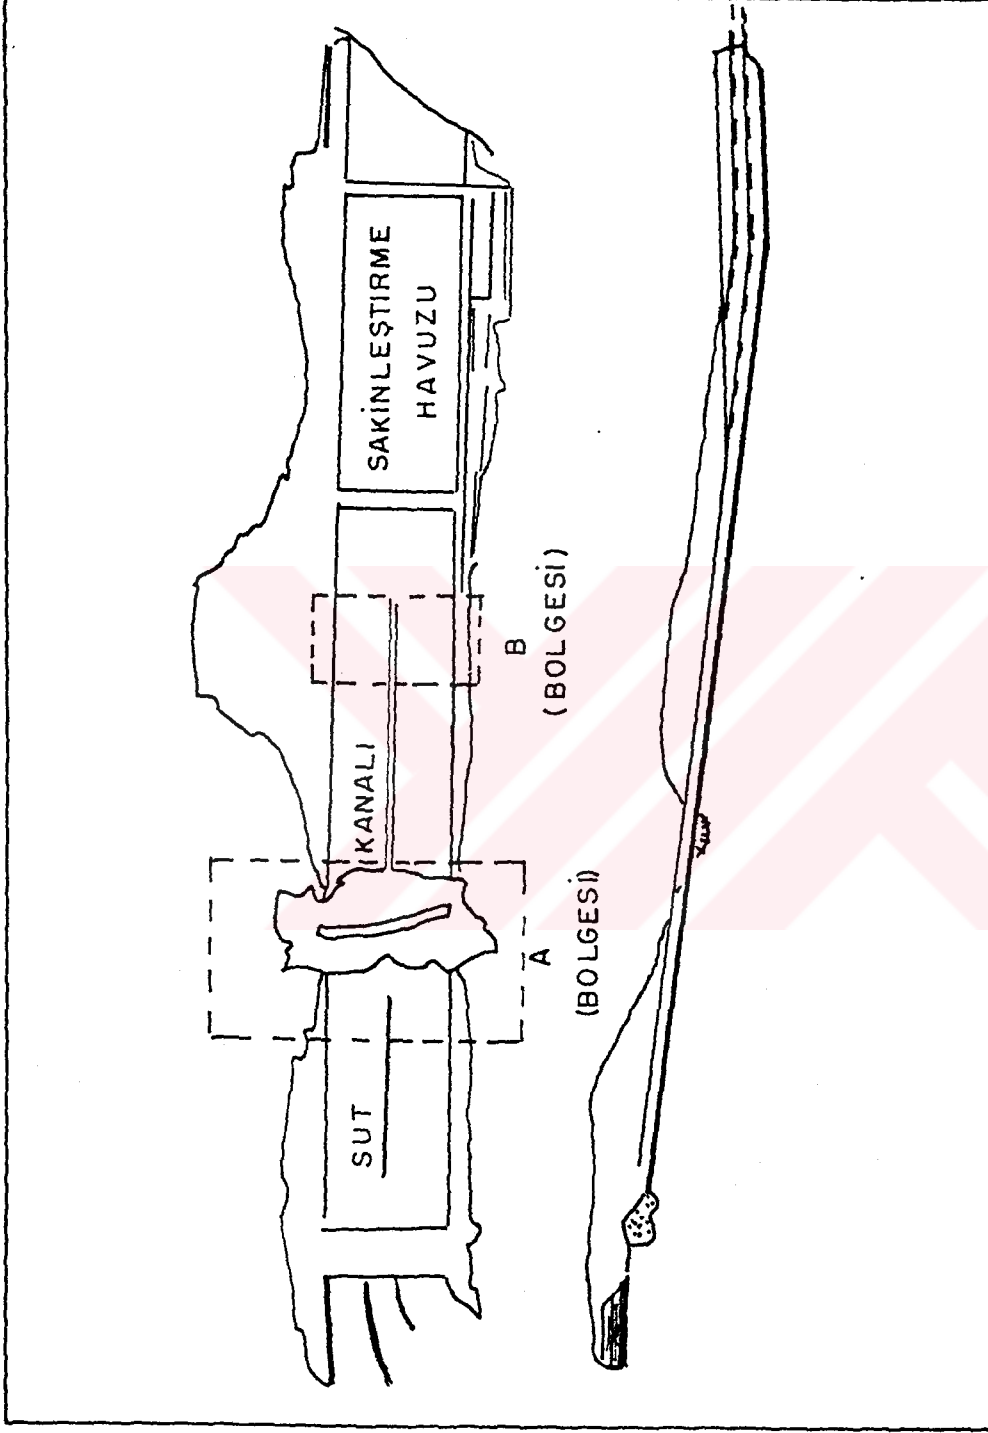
Atatürk Barajı Genel Vaziyet Planı
